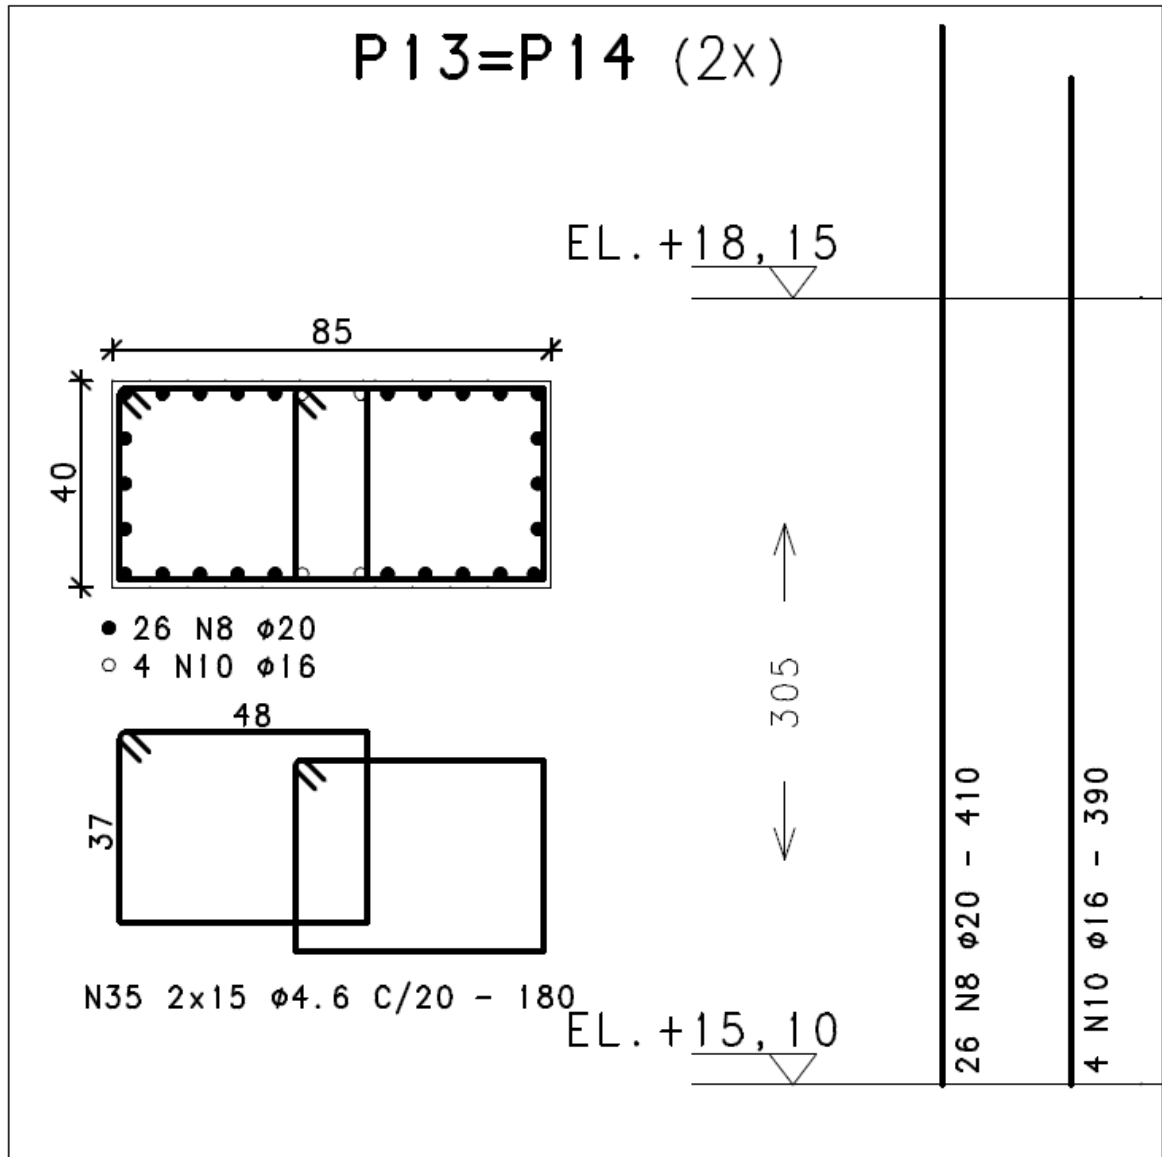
Armação dos pilares P13 e P14 de um lance do pavimento tipo.
